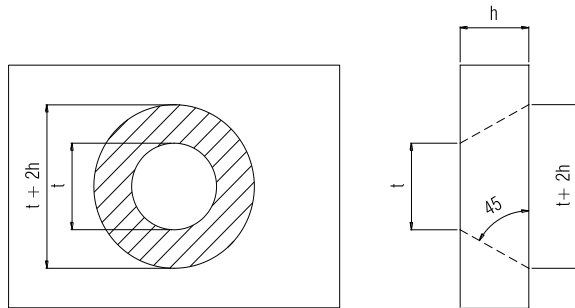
16. Geser Pons Kolom Pilar terhadap Pile Cap
